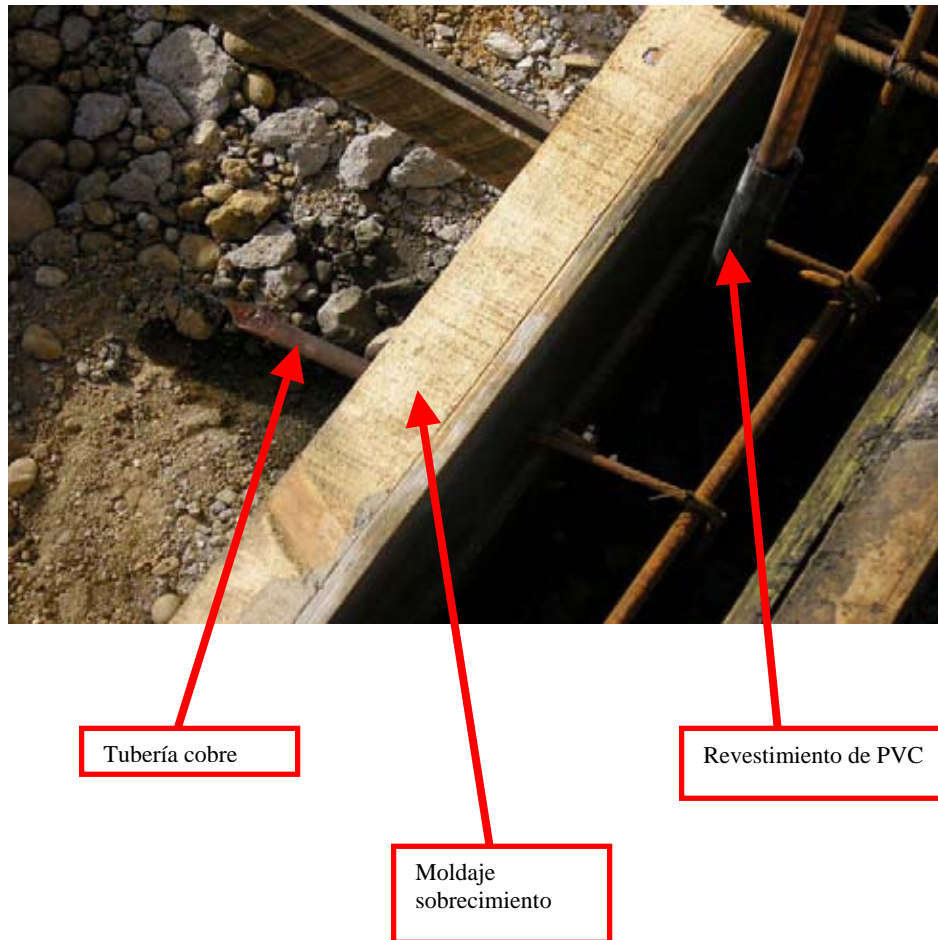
pasadas de tuberías en moldaje de sobrecimiento
